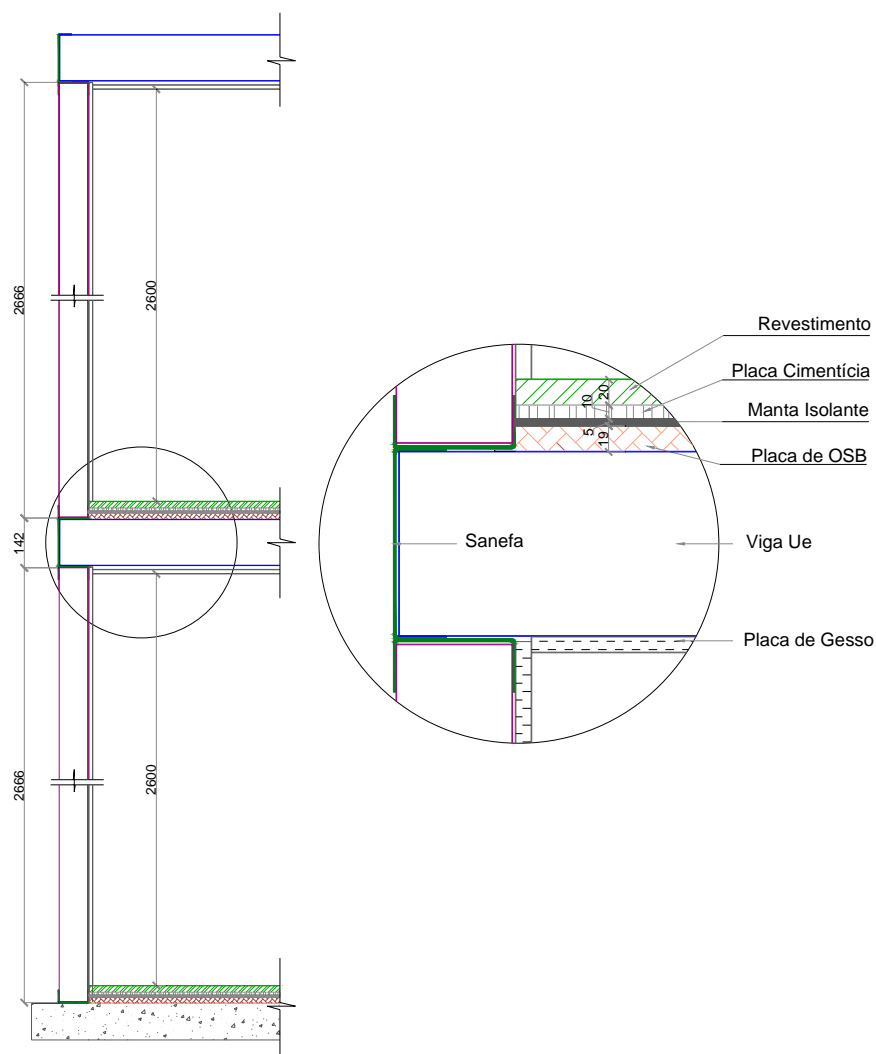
Configuração de piso seco utilizada para os modelos de 4 pavimentos
